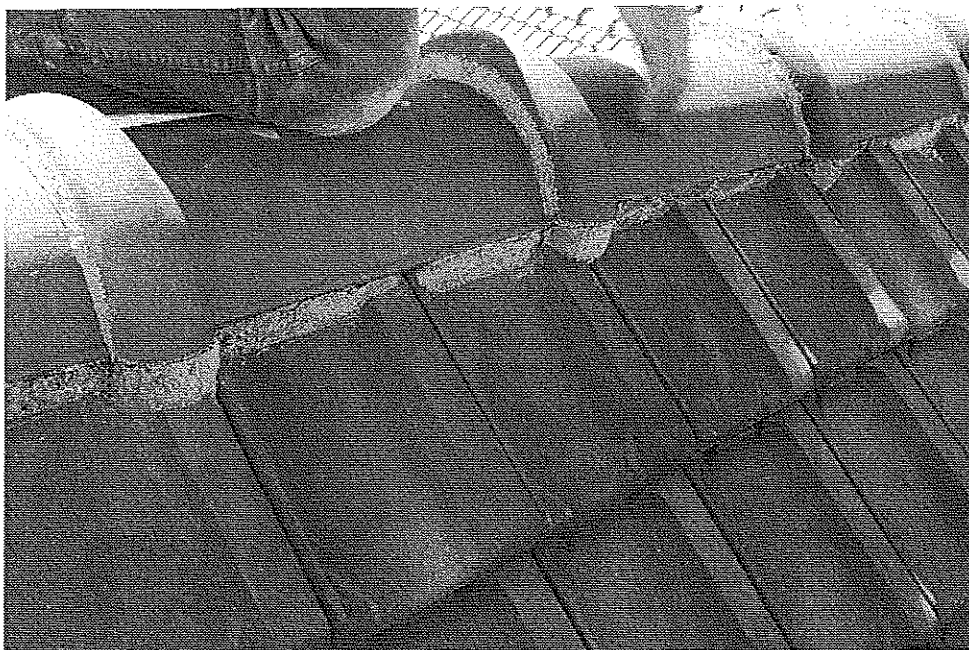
Fissurations du mortier de pose entre les éléments de faîtage et les tuiles.
